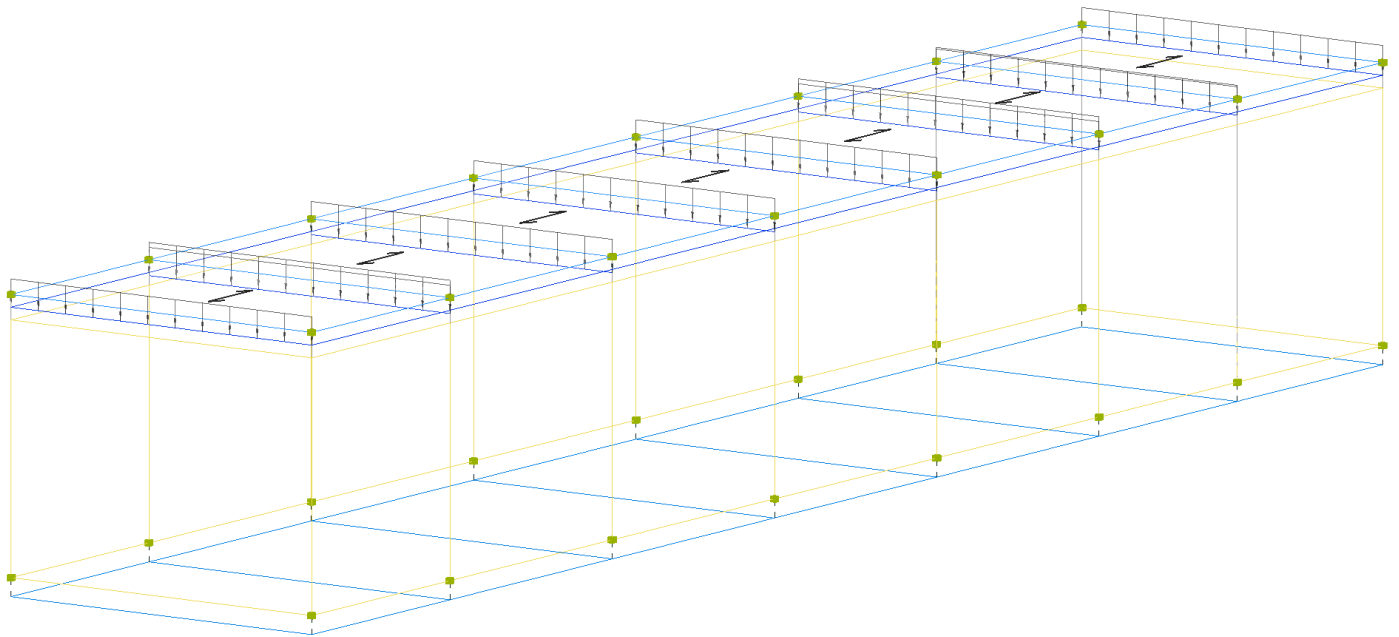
Applicazione carico permanente non strutturale solaio (QFissi solai).
